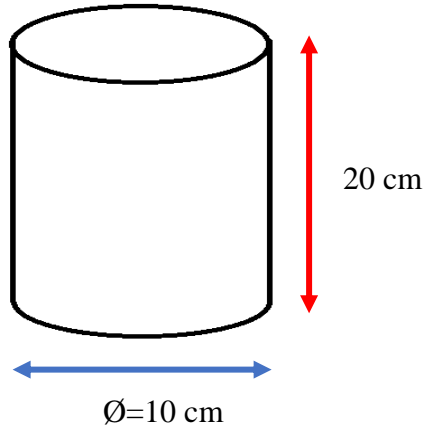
Dimensiones de la probeta cilíndrica de hormigón.
